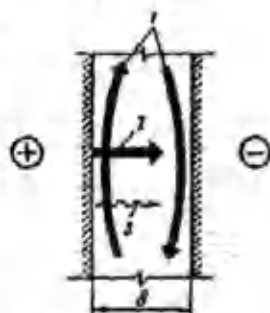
Схема передачі тепла через повітряний прошарок:
